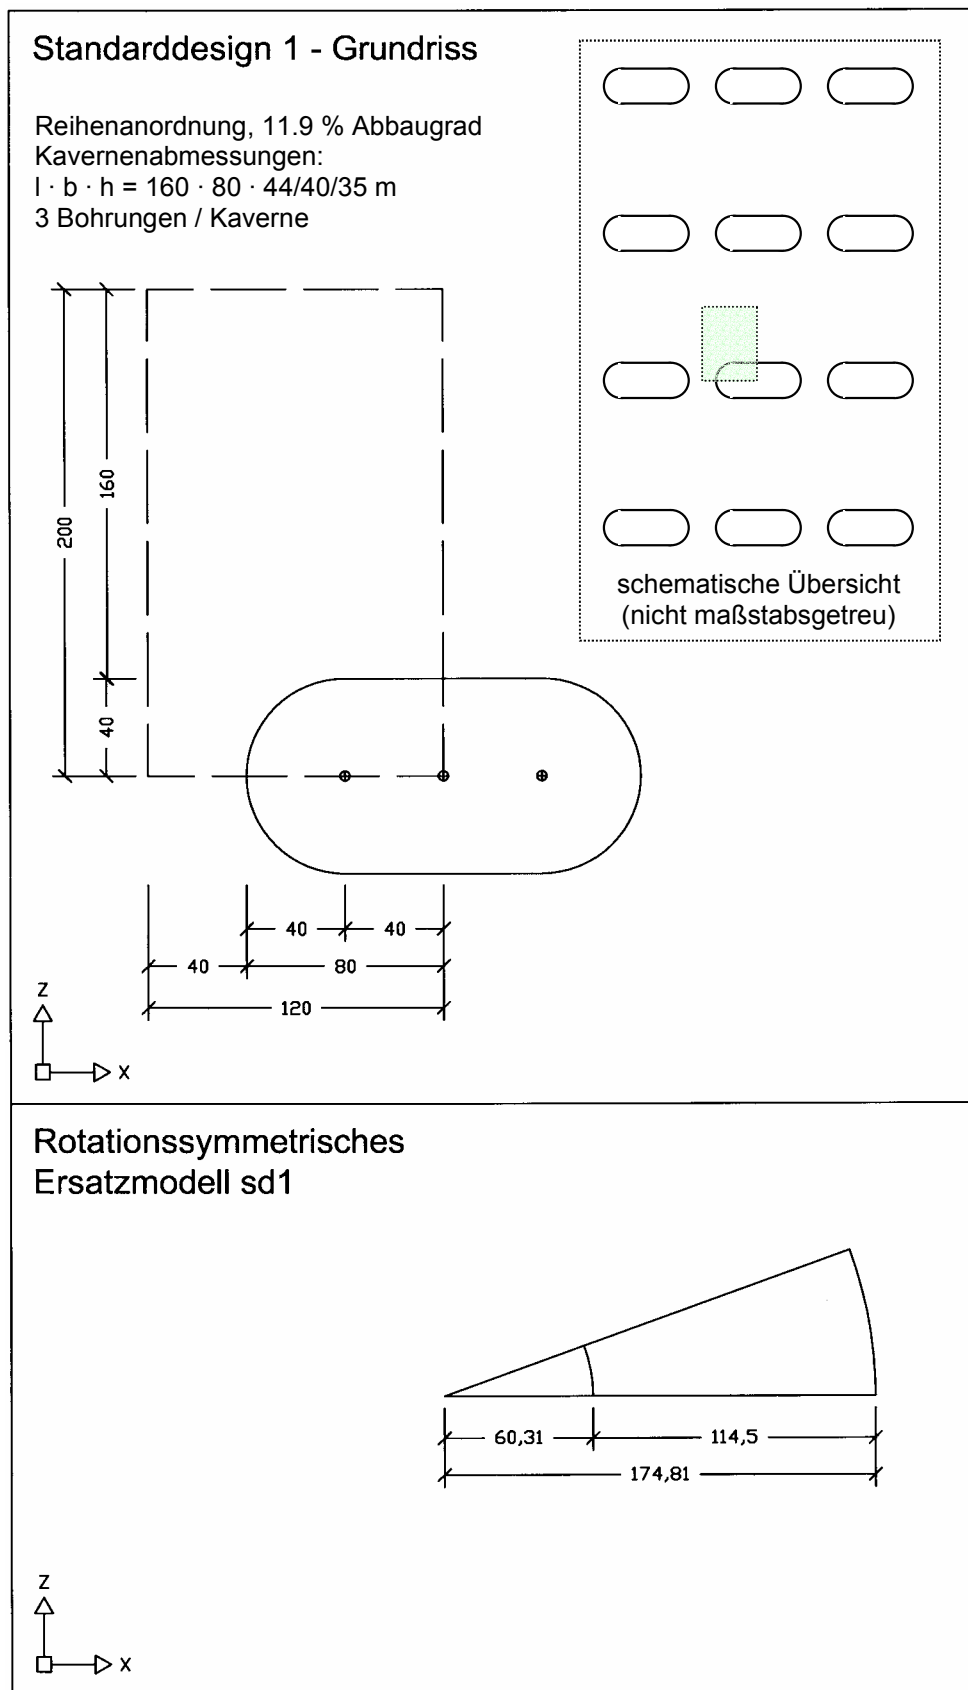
Standarddesign 1 – Grundriss und rotationssymmetrisches Ersatzmodell
